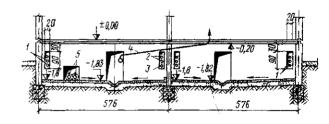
Схема размещения коммуникаций в техническом подполье здания при строительстве на просадочных грунтах
